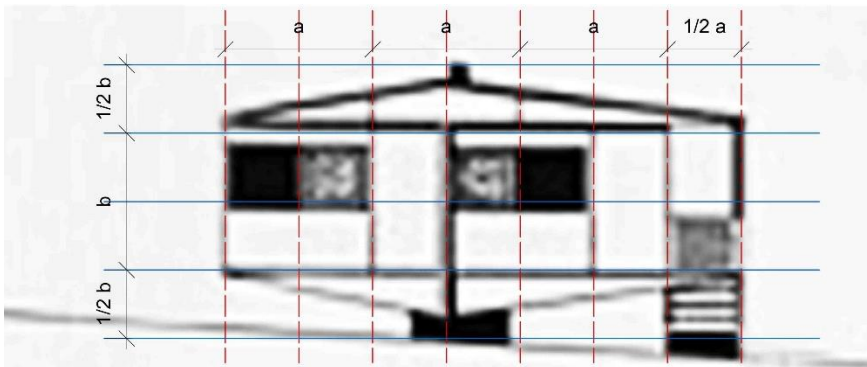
1943, Plas-2-Point House. Primera vivienda prefabricada por Marcel Breuer. Modulación del Porche con relación a la vivienda. Fuente: Autor.
